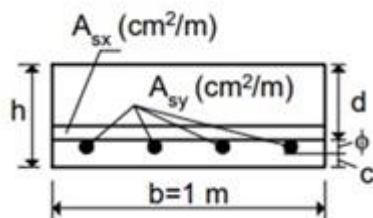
Esquema de seção retangular de laje maciça de concreto armado. (Fonte: Araújo, 2014)
